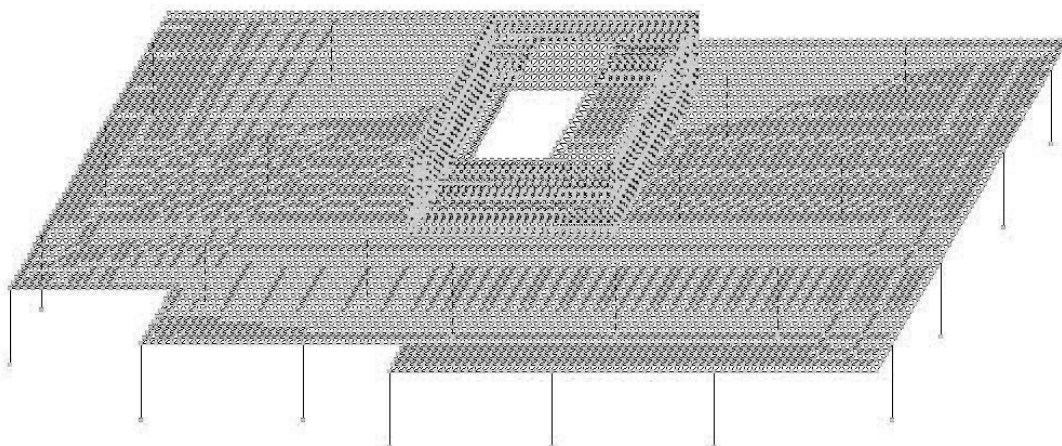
Плита перекрытия в комбинированной расчетной схеме
